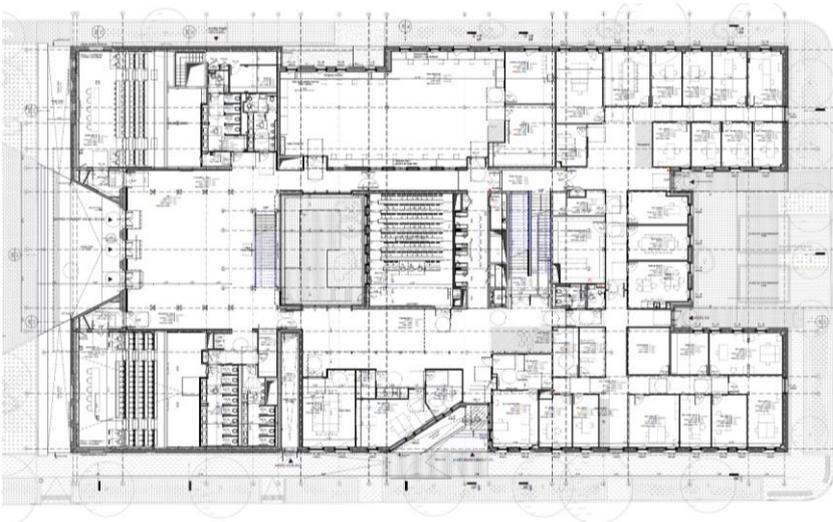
Plan du rez-de-chaussée. @ArtBuild
